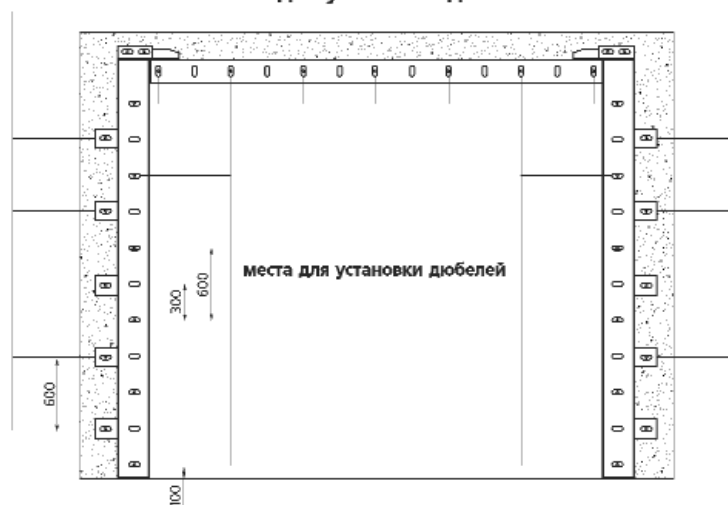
Схема крепления вертикальной рамки несущего каркаса ворот.
